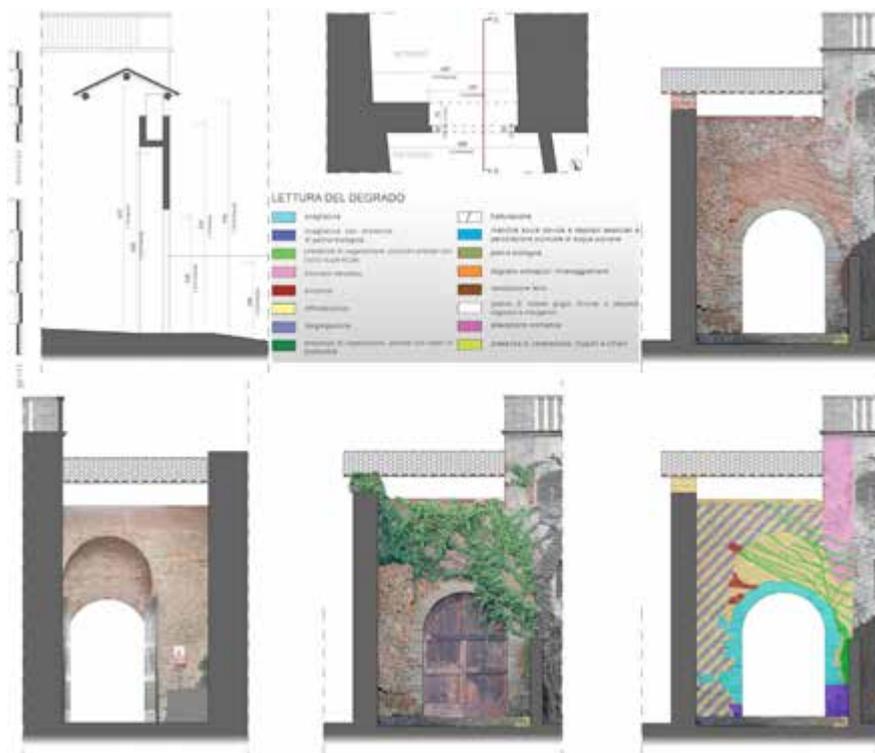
La lettura del degrado: la Porticciola: Immagini, pianta con risalita, prospetto esterno quotato, sezione, prospetto esterno fotopiano, prospetto interno fotopiano, prospetto esterno fotopiano durante la fioritura, prospetto esterno con degrado
